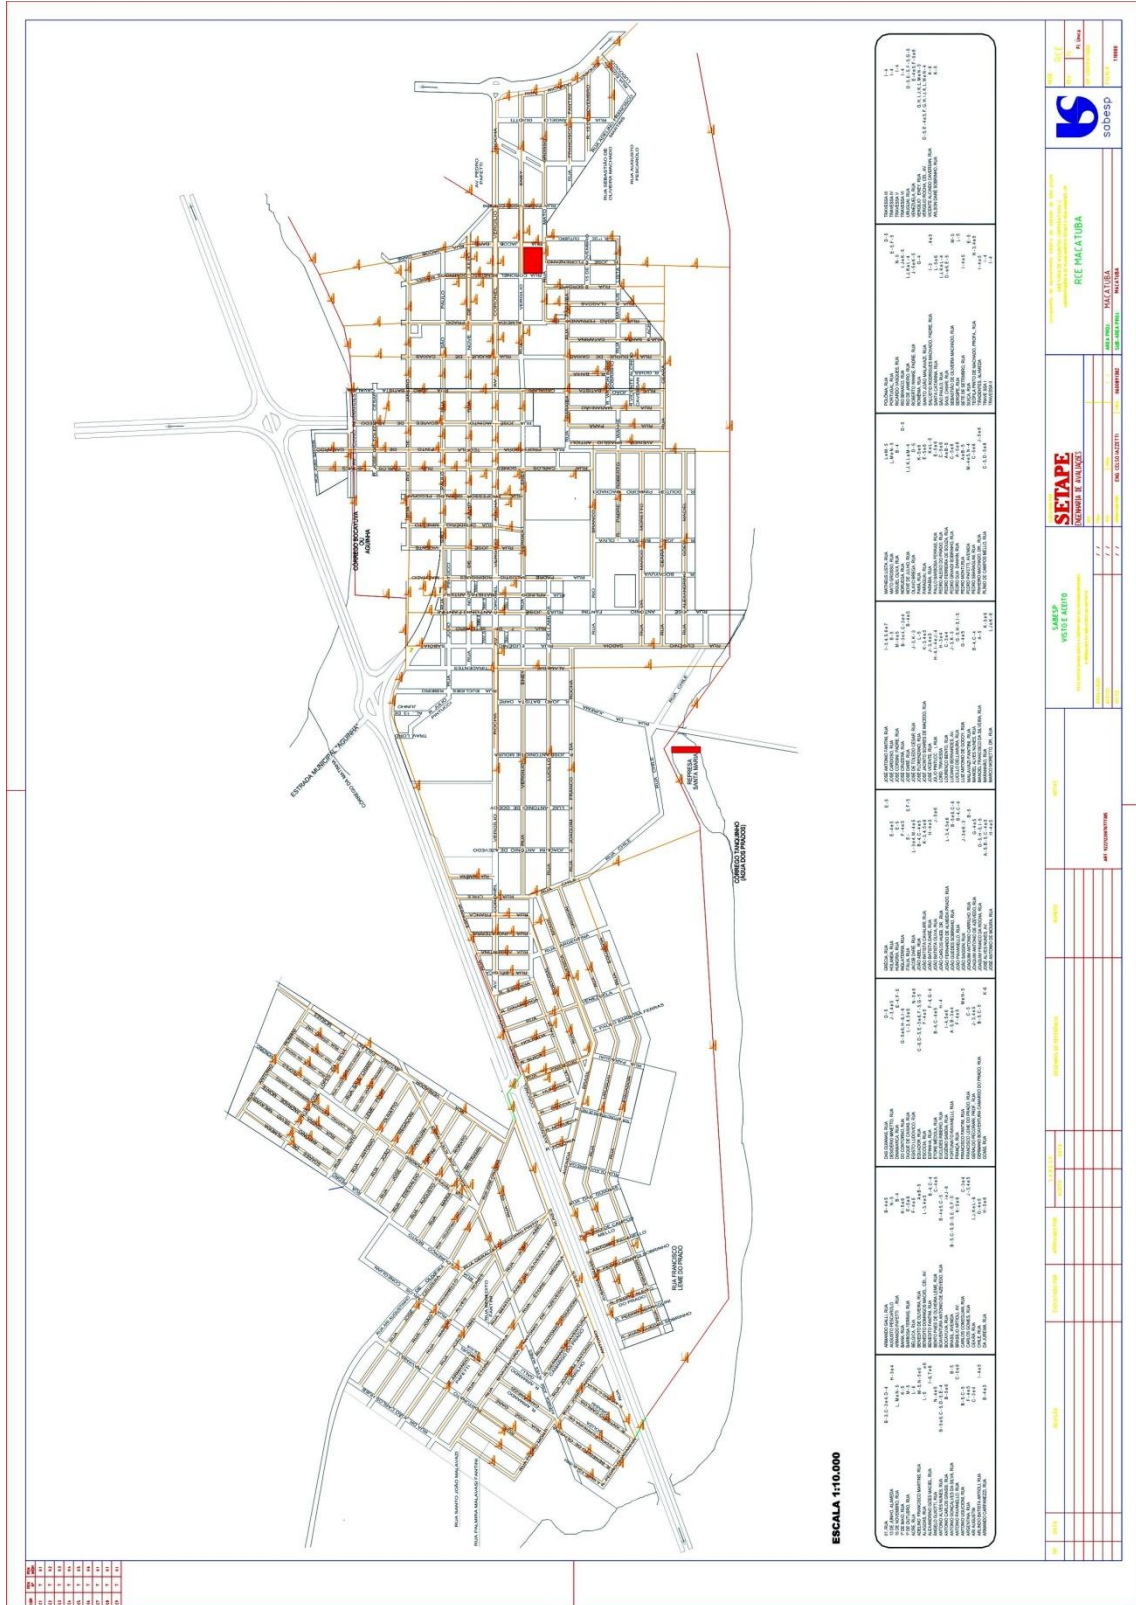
PLANTA CADASTRAL DA REDE COLETORA DE ESGOTO - SABESP
